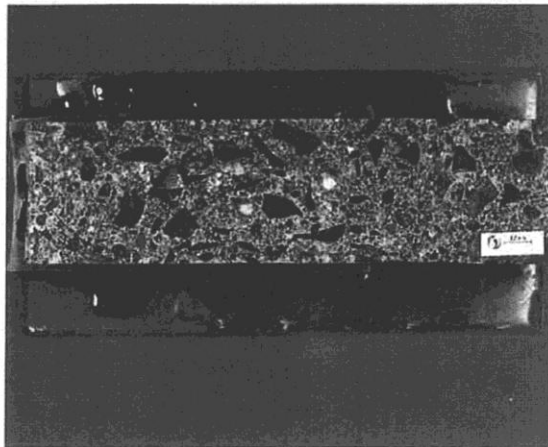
Bildet viser planslipet av kjerne A1. Overflaten er til venstre i bildet
